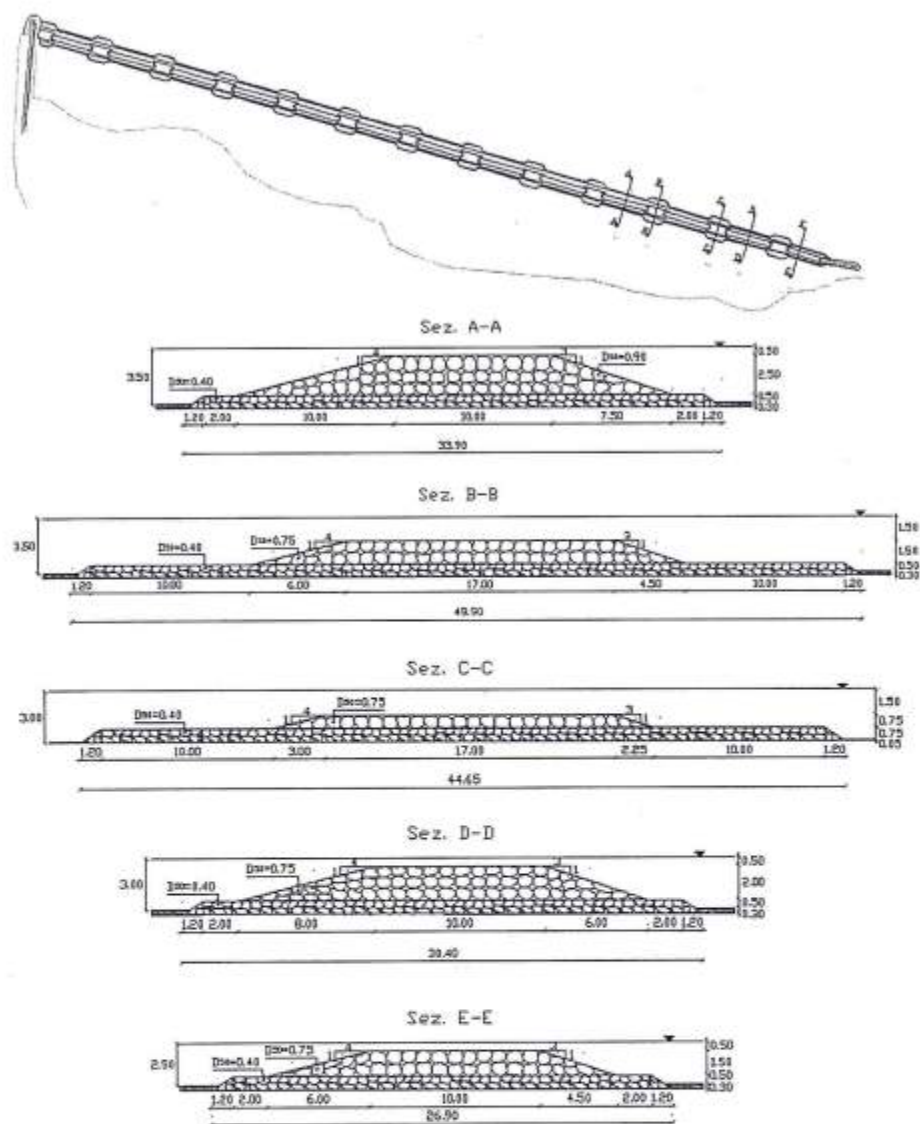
Pianta e sezioni trasversali della barriera sommersa, I Alternativa.
